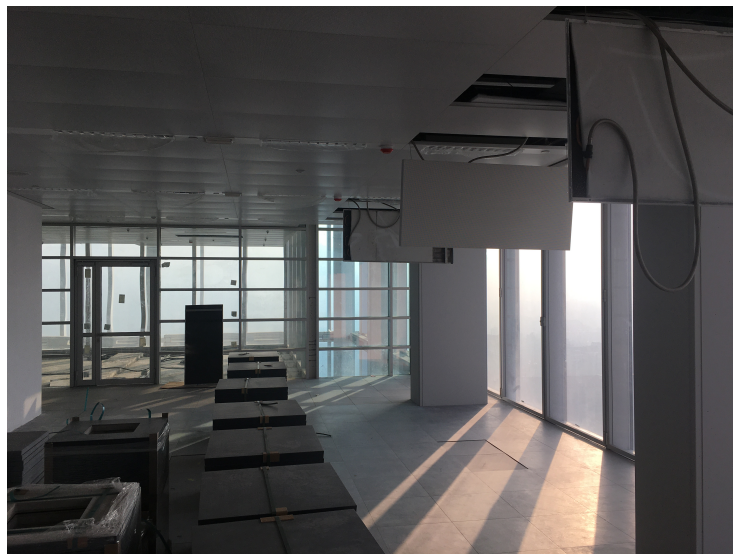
Avanzamento dei lavori Piano 15 - vista lato Est Grande vuoto
